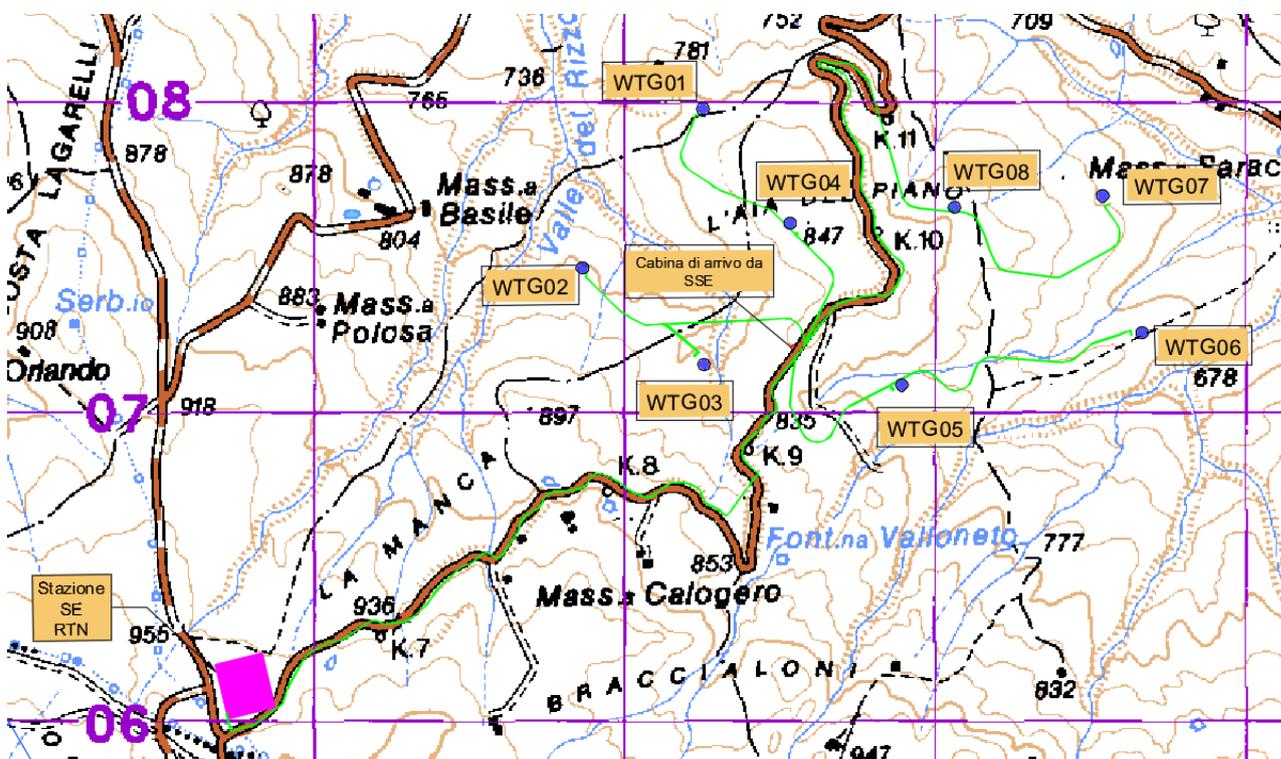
Planimetria di inquadramento del parco eolico e delle opere di connessione alla rete su IGM
